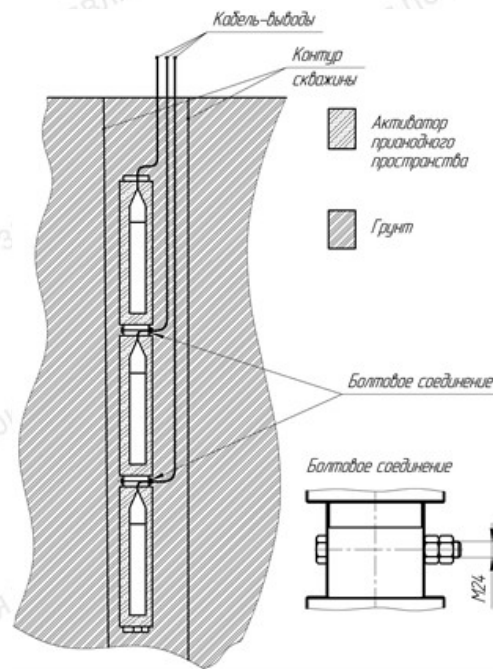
Общий вид, габаритные размеры и способы установки анодных заземлителей АЗЖК-РА-ГУ
